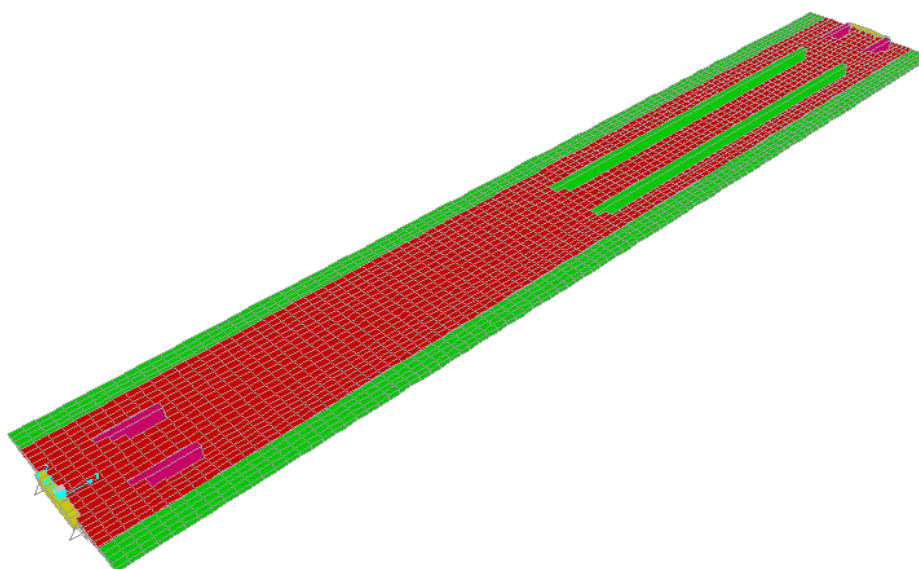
Vista 3D do modelo– Alternativa 1/11
